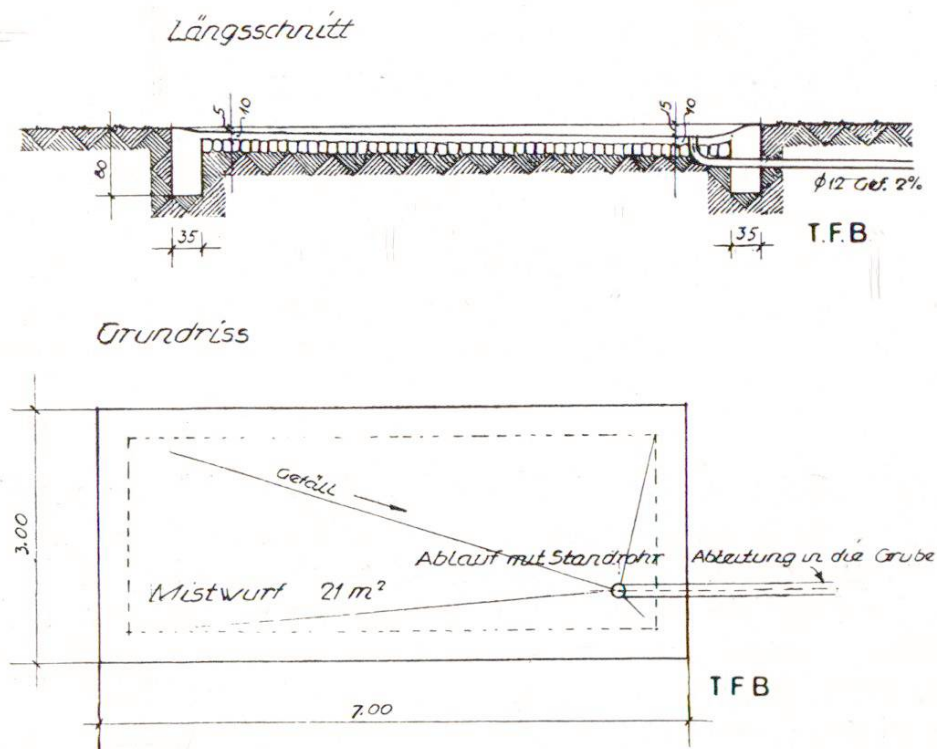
Aire à fumier de 21 m². Coupe longitudinale et plan
